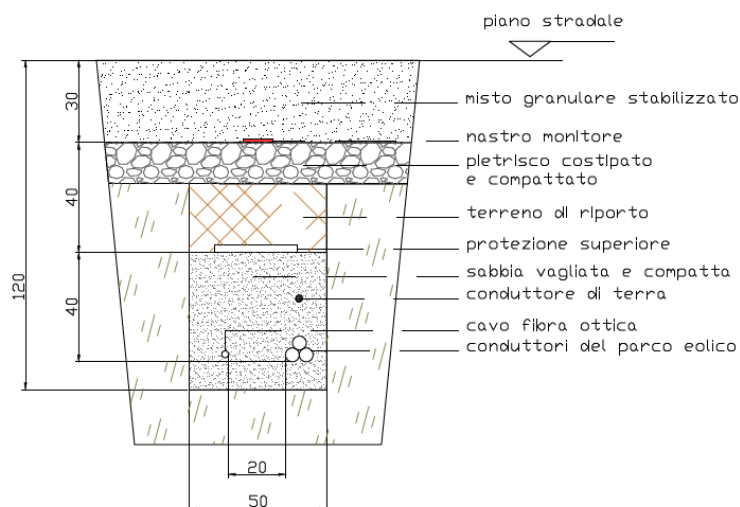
Tipico del cavidotto in MT interrato, posa di un singolo conduttore tripolare sotto strada sterrata
